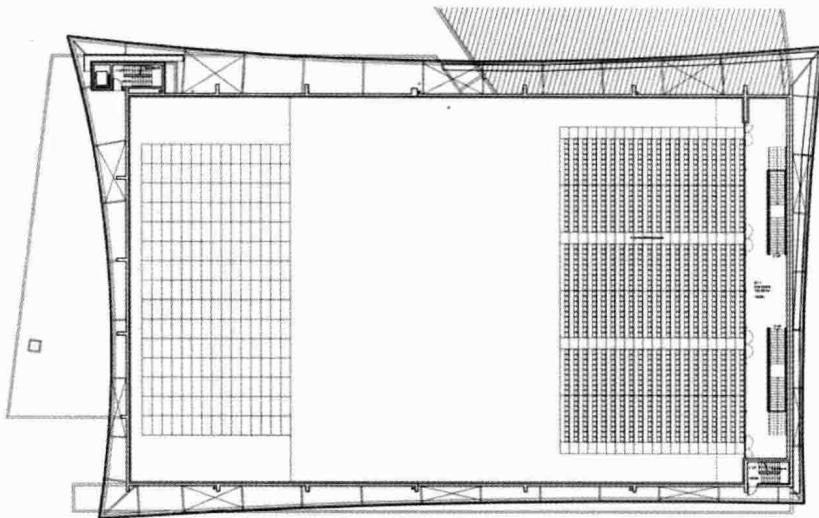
Brisac Gonzalez 设计的 Le Prisme 剧院平面图
